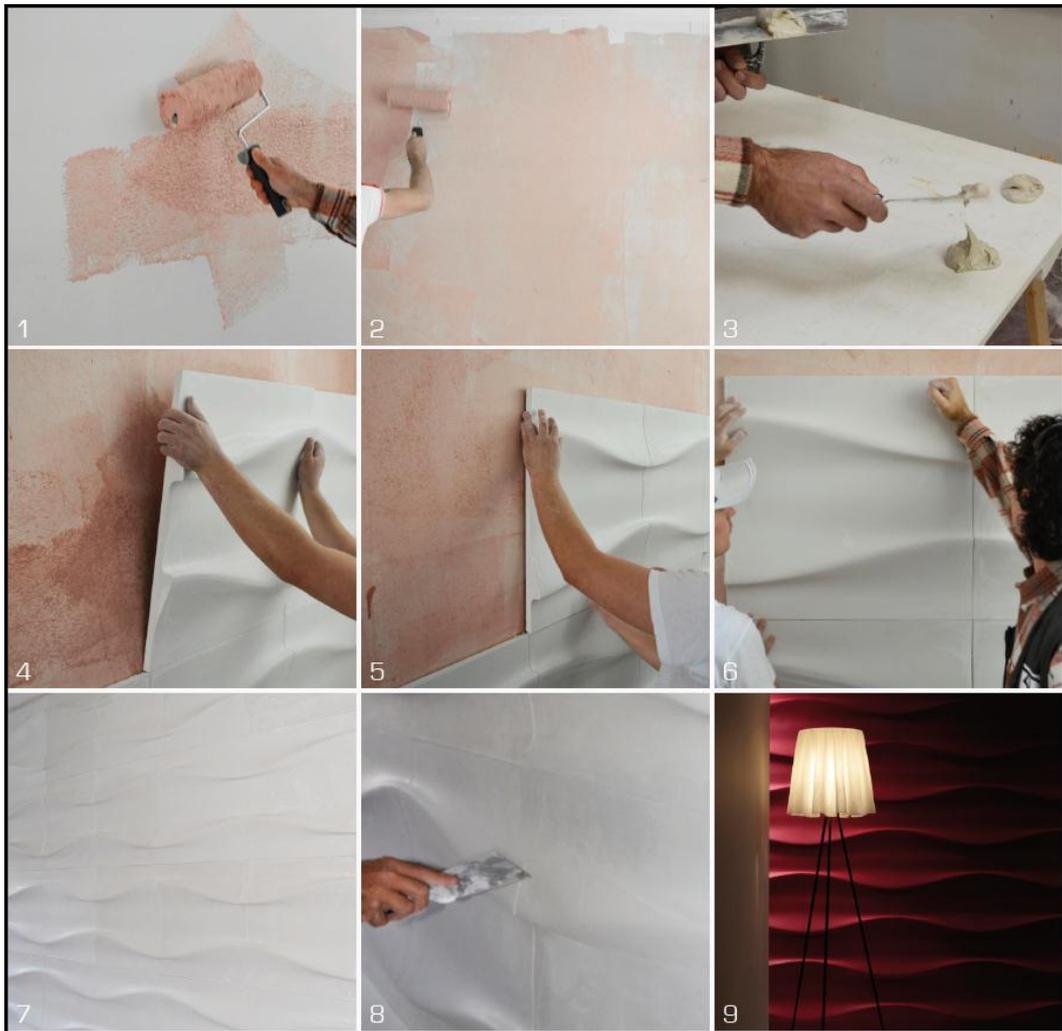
Fasi di montaggio del sistema 3D Surface <http://www.3dsurface.it>.
